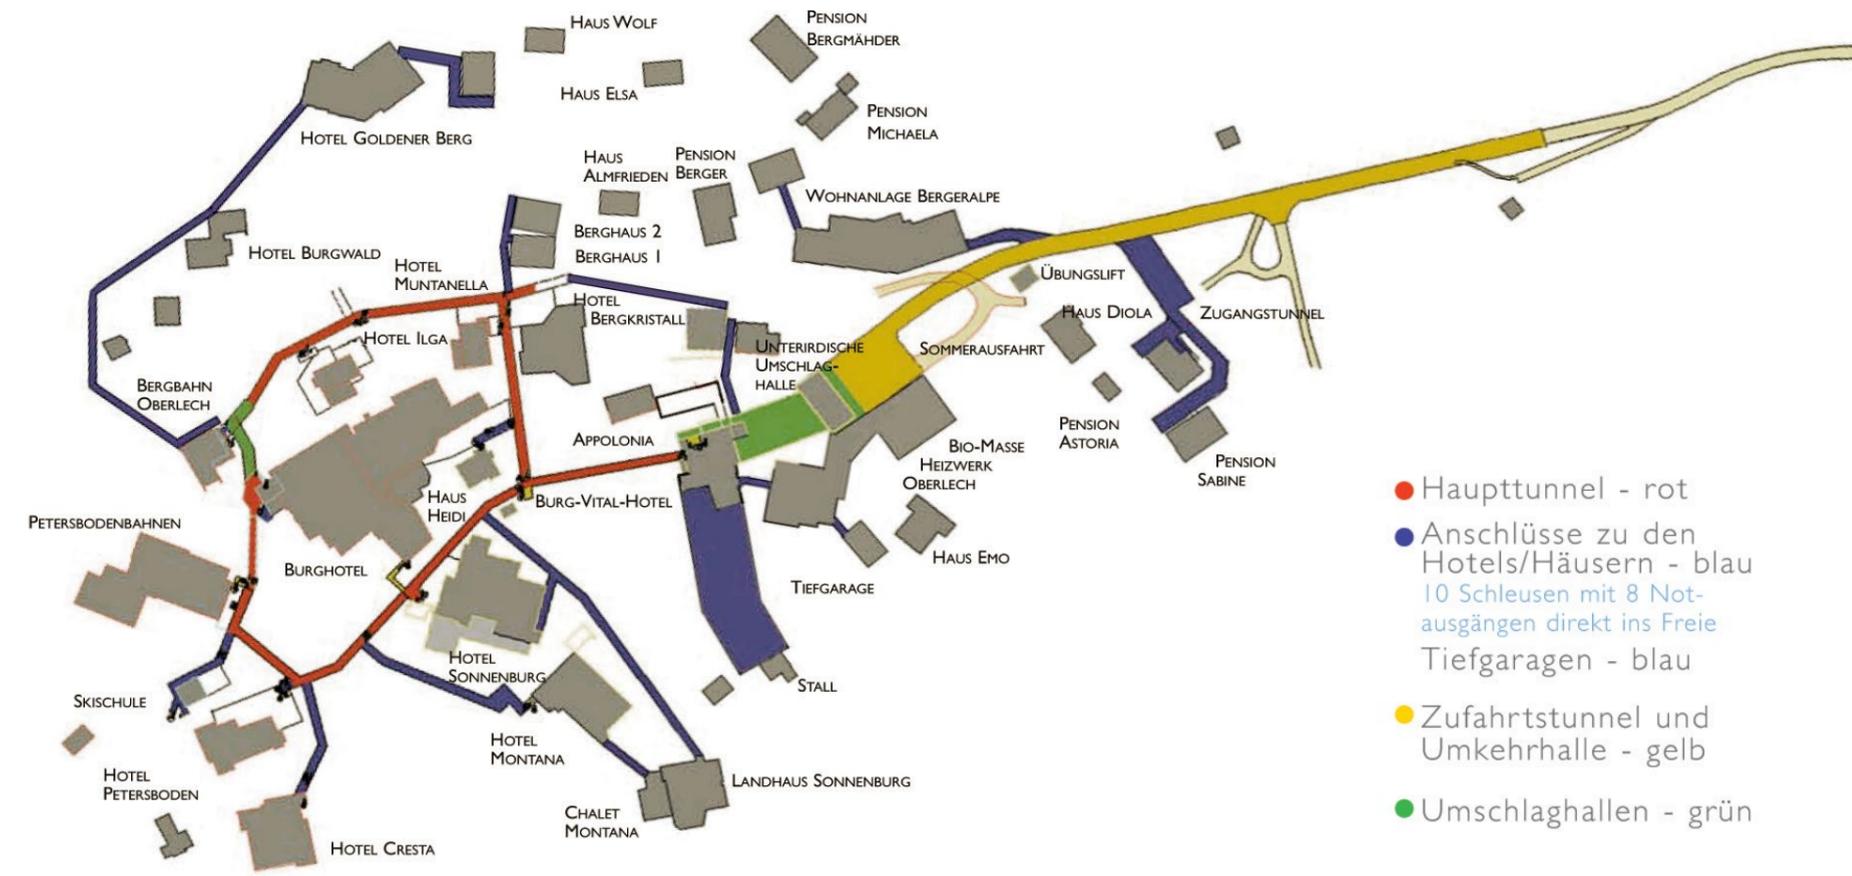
| Plan des unterirdischen Tunnelsystems Oberlech
